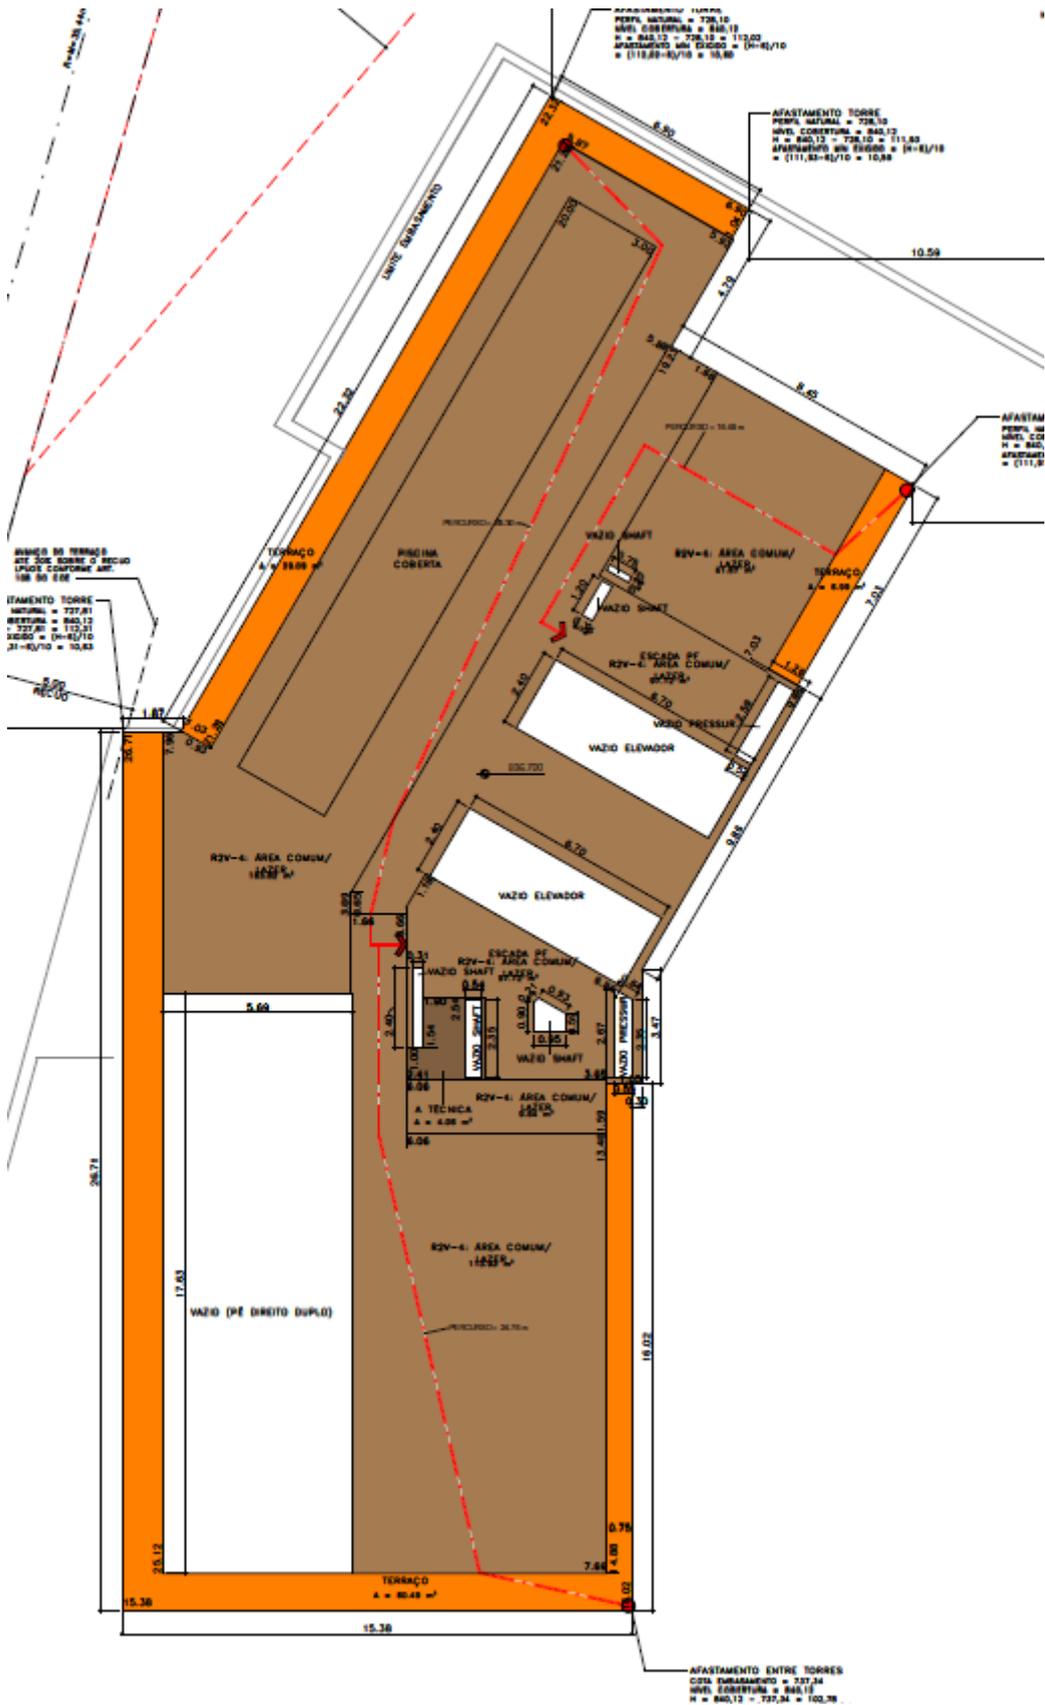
Torre 3 - 36º pavimento. Setor B2.
